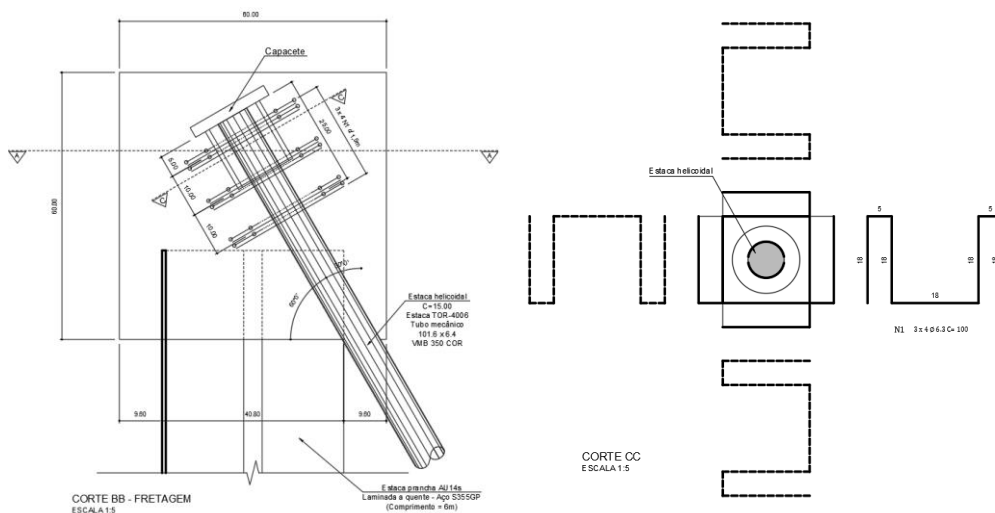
Projeto estrutural da viga de coroamento, detalhe da fretagem
